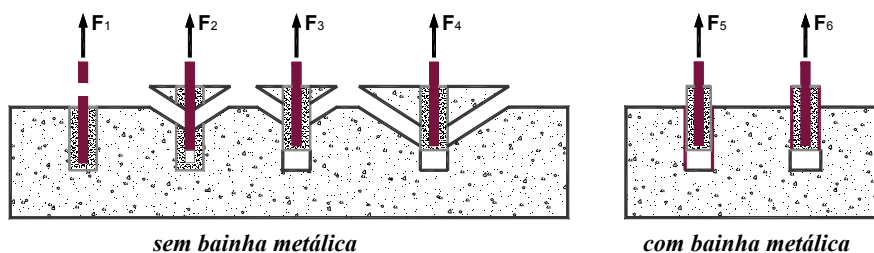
Modos de rotura de um varão embebido no betão: (1) rotura pelo aço em tração; (2) rotura por aderência entre o varão e o grout; (3) rotura por aderência entre o betão e o grout; (4) rotura por arrancamento do betão; (5) rotura por aderência entre a bainha e o betão; (6) rotura por aderência entre a bainha e o grout.
